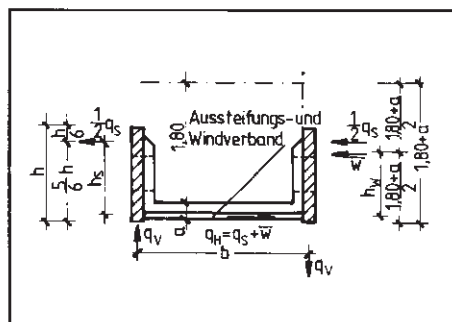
Angreifende Belastung für Aussteifungs- und Windverband bei mit Verkehrslast belasteter Fußgängerbrücke mit untenliegender Verkehrsbahn
